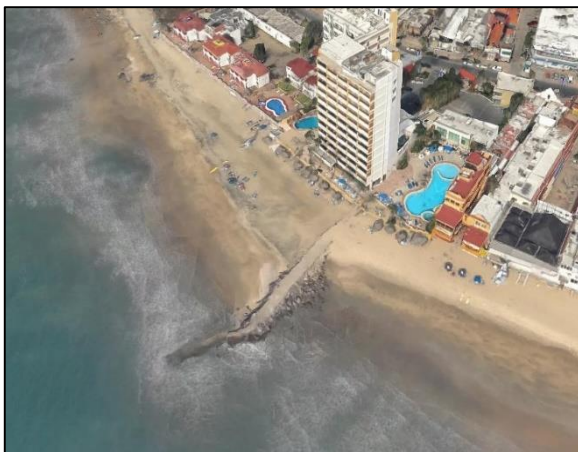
Ubicación de espigón construido frente hotel Las Flores.
